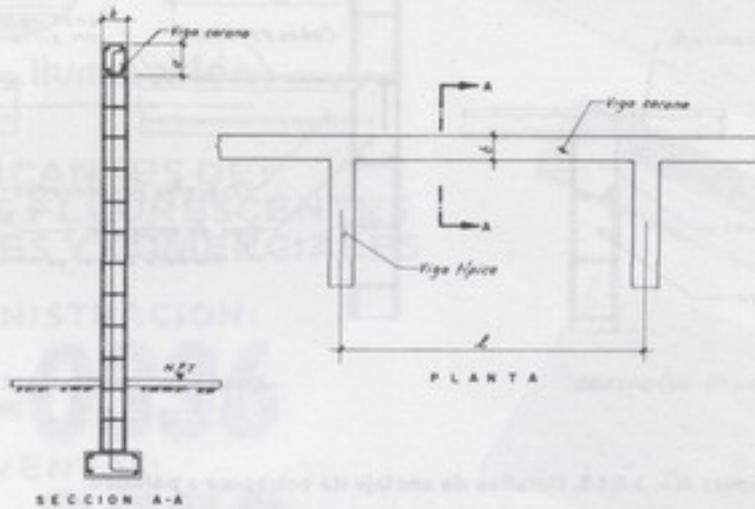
Detalle de viga corona para rigidizar paredes.
